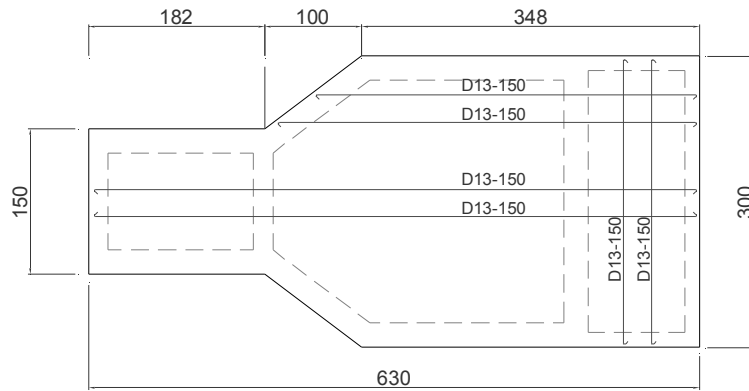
Potongan 2 bangunan pengambilan bendung
